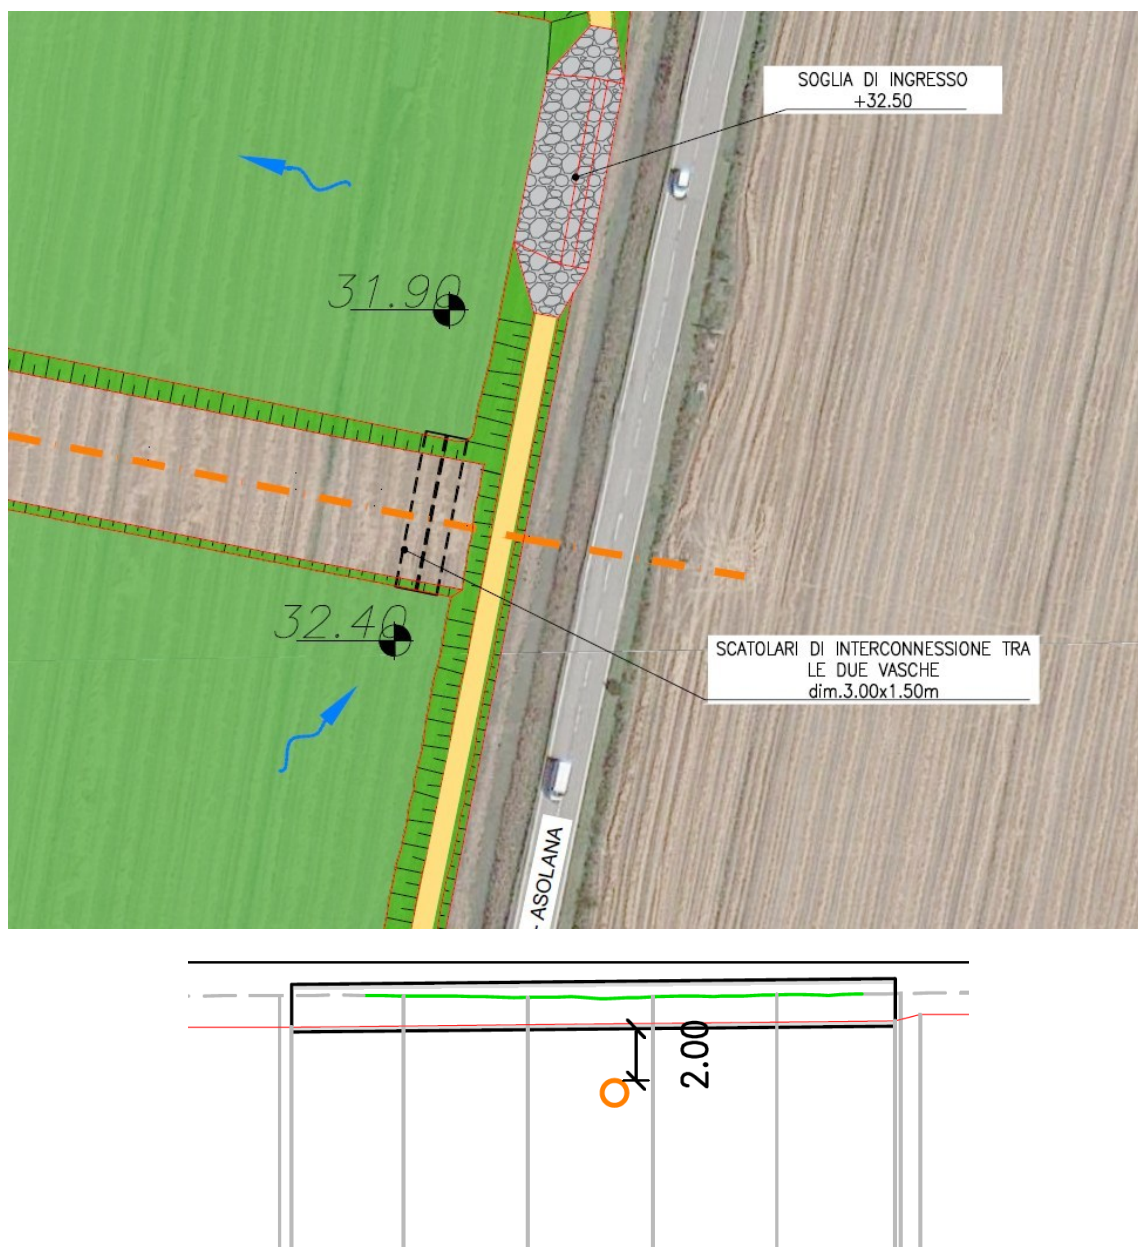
stralcio planimetria di progetto nella zona di interferenza tra le opere in progetto e la tubazione SNAM e relativa sezione
